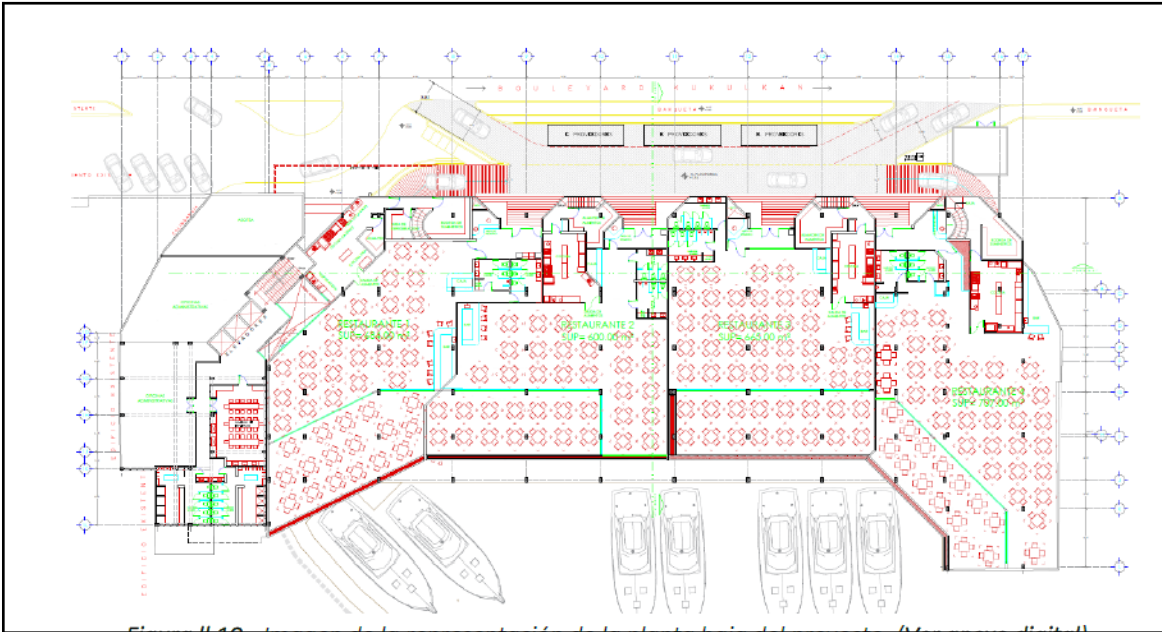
Imagen de la representación de la planta baja del proyecto.
